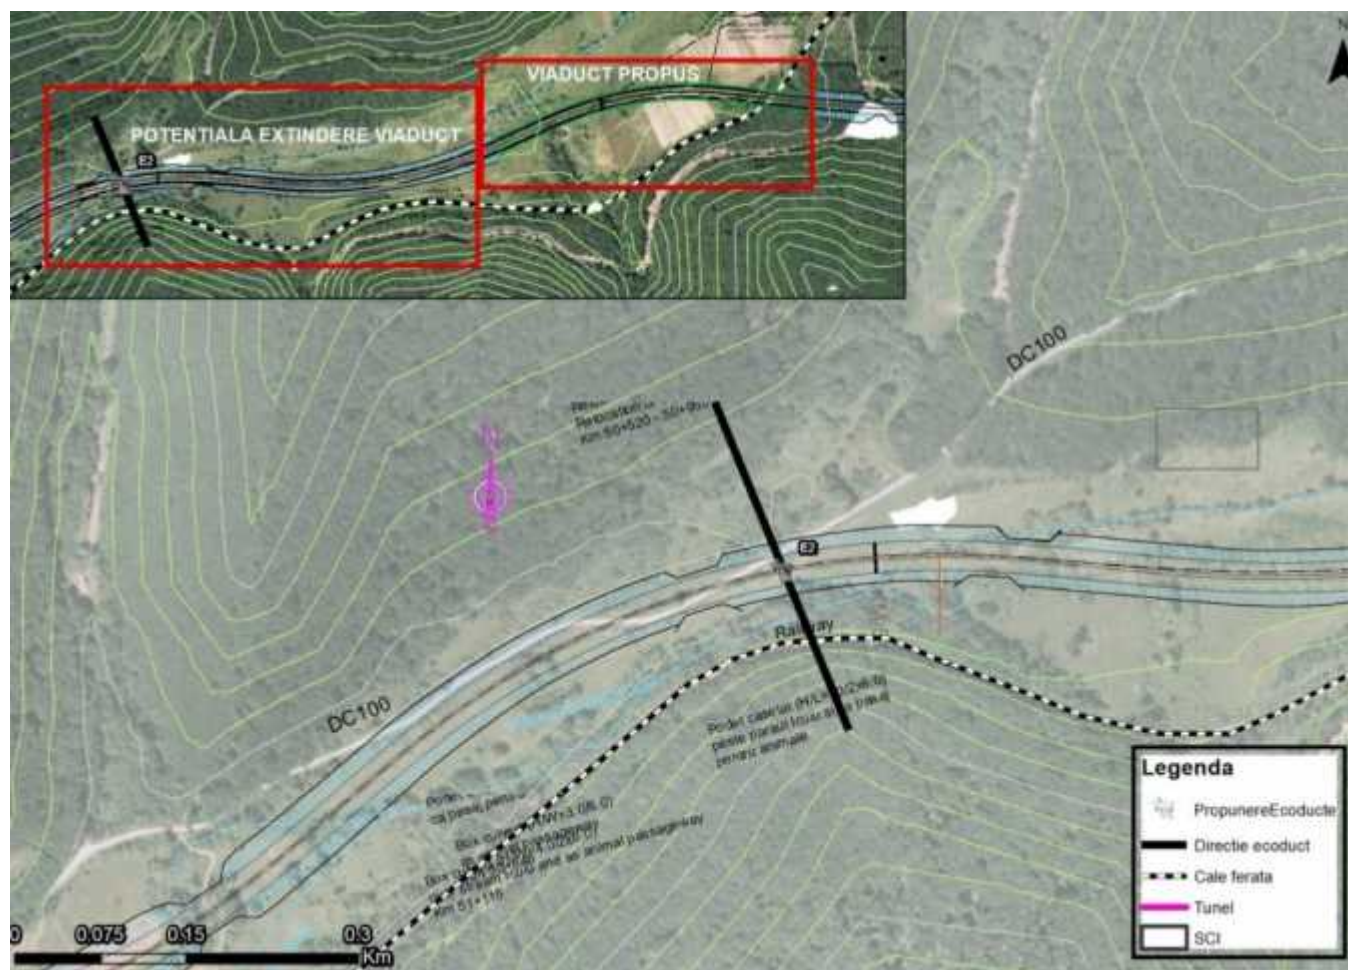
Propunere Ecoduct 2, detaliu plan autostrada
